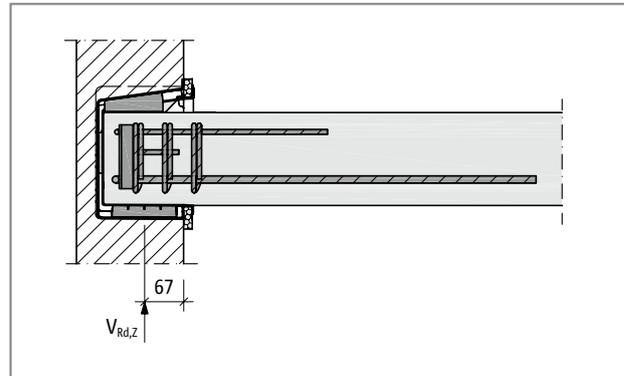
Schöck Tronsole® tipo Z, raffigurazione della linea d'azione della forza di appoggio nella parete
